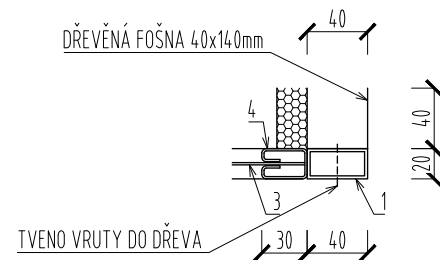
DETAIL ŘEZ RÁMEM ROHOŽE- M 1:5
